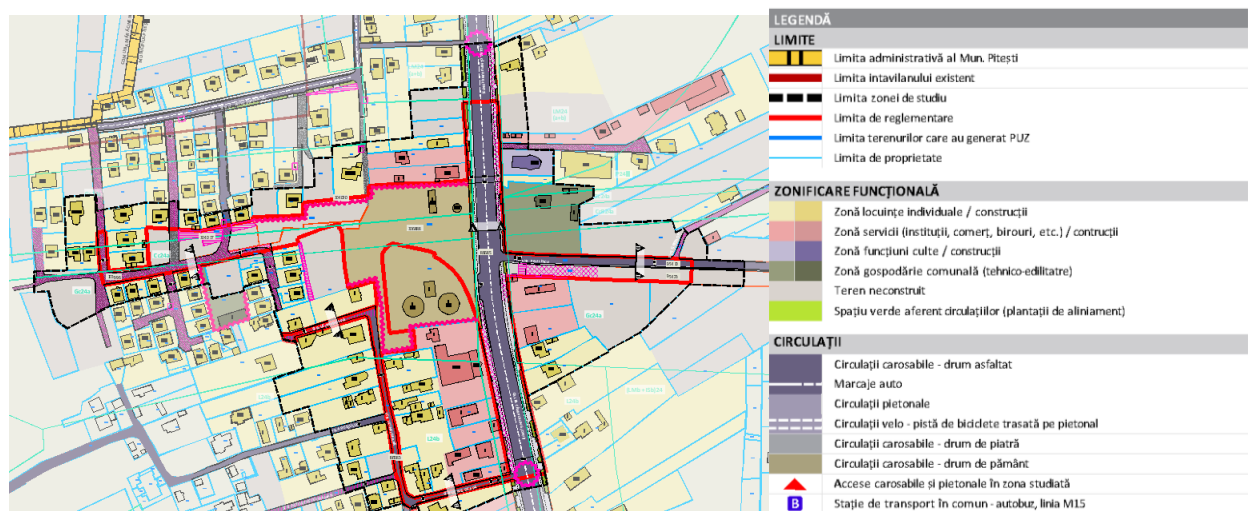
Plan situație existentă Călea Câmpulung (DN73)
